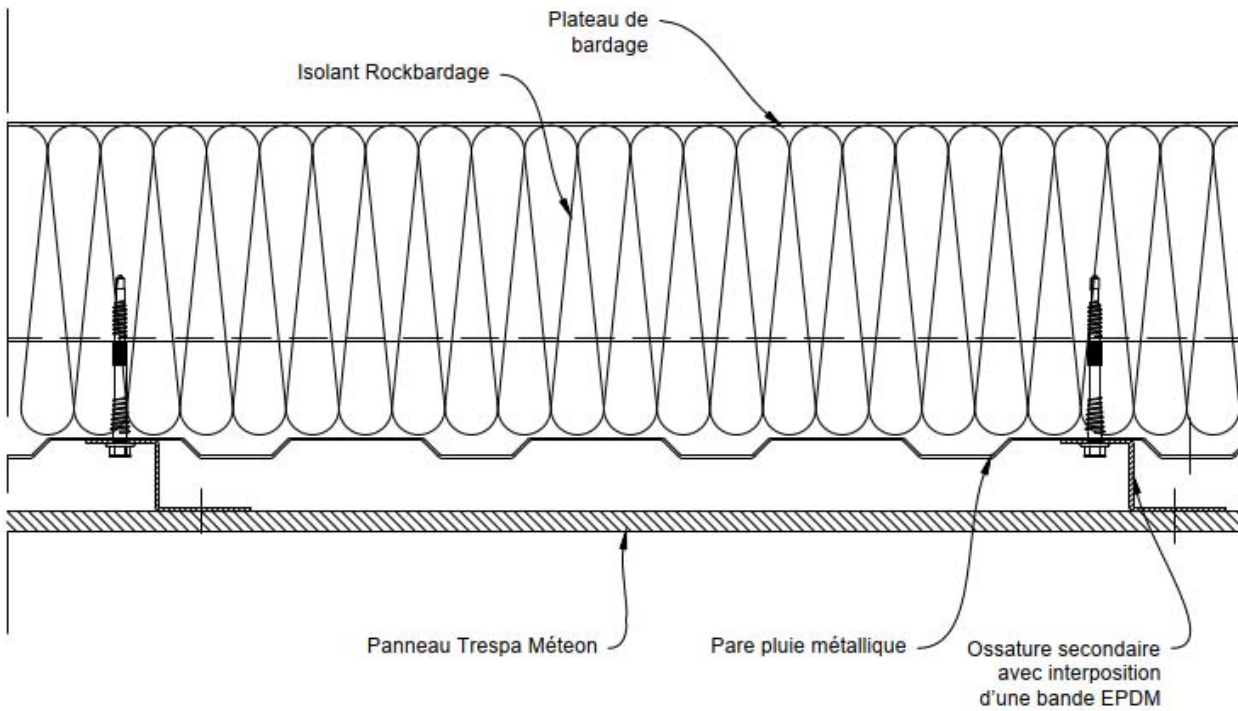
Joint vertical entre panneaux Trespa® Meteor®.
